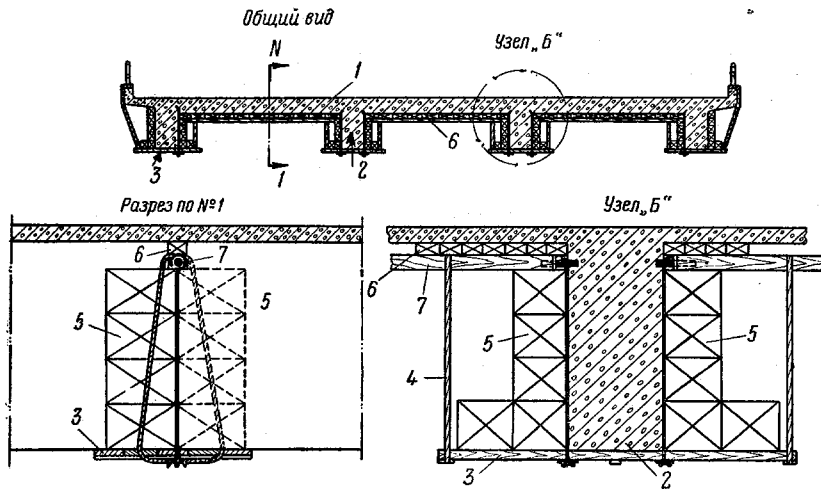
Крепление зарядов к балкам и плите железобетонного моста (в одном сечении пролетного строения):
